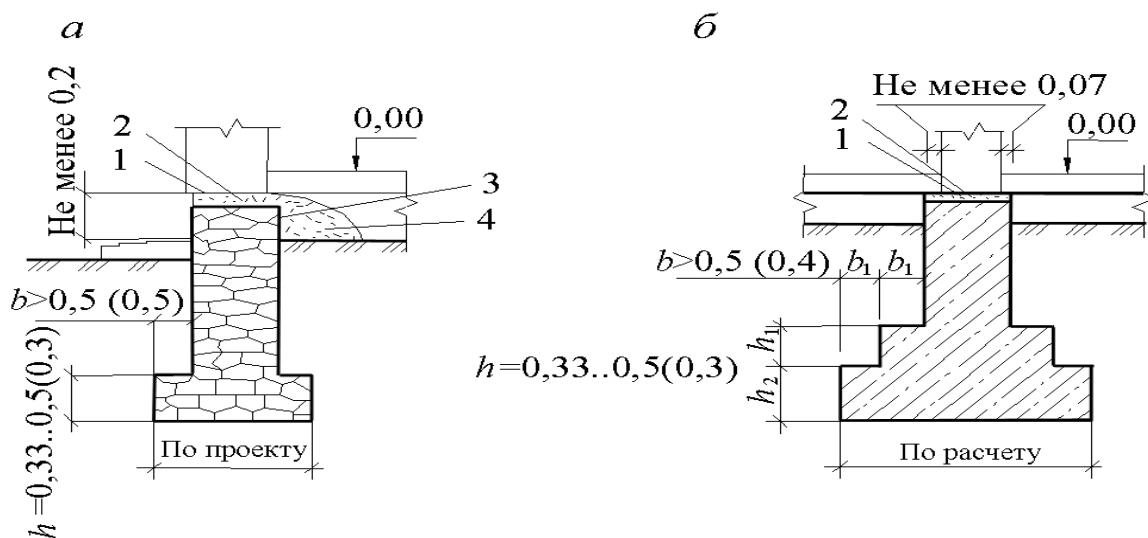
Бутовые и бутобетонные фундаменты с уступами:
